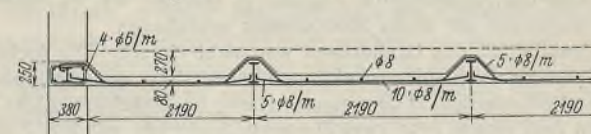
Querschnitt der ausgeführten Deckenkonstruktion.
